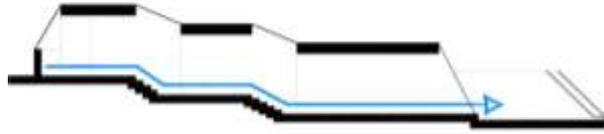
Sección de Jaffe House mostrando el recorrido.
